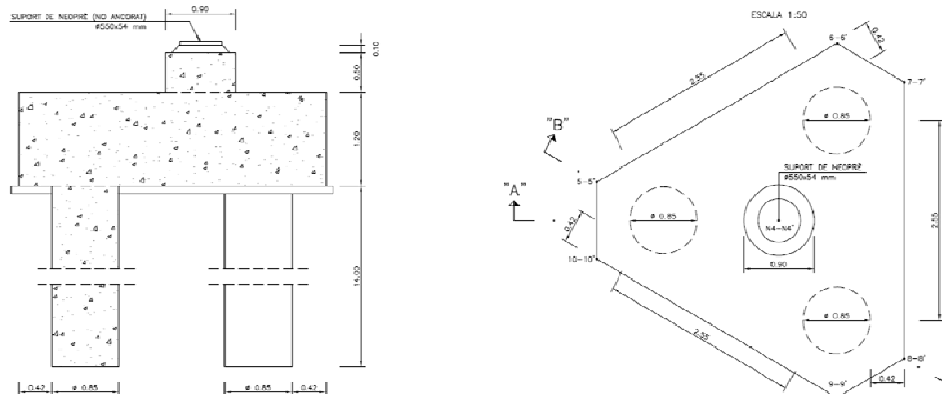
Plànol núm.19.2 full 4 Secció A i planta.
